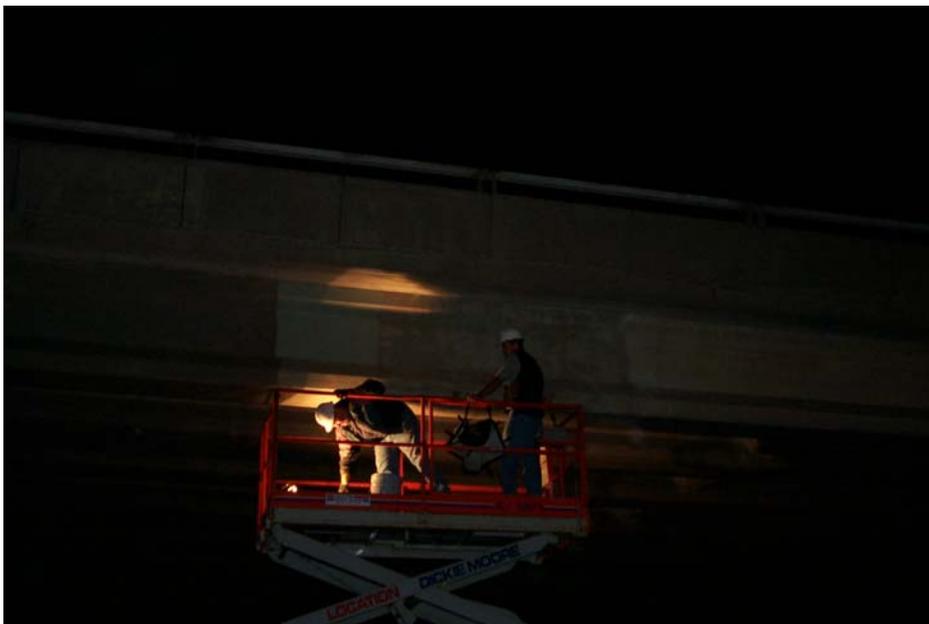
Application d'enduit sur la poutre de rive nord
